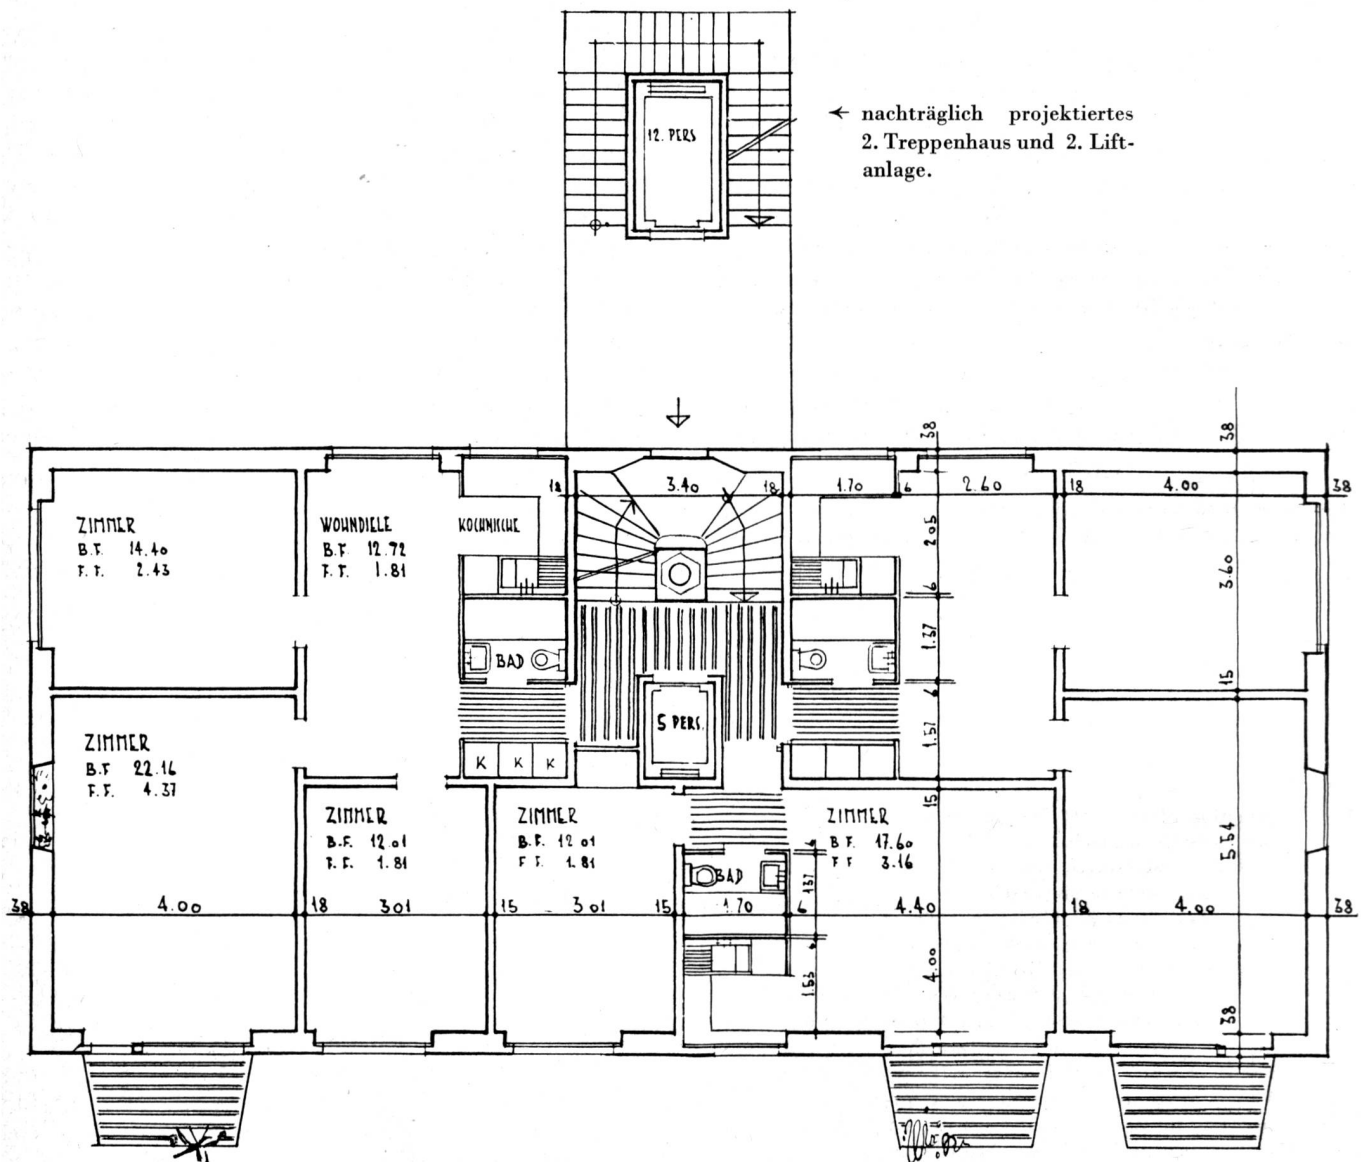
Grundriss eines Normalgeschosses. Nach dem ursprünglichen Projekt sind pro Stockwerk drei Wohnungen vorgesehen. Der Grundriss entspricht einem normalen Dreispännertyp, wie er für 4–6 Stockwerke üblich ist. Als vertikale Verkehrsanlage sind eine 1,25 m breite Treppe und ein Lift (Kabinengrösse 90 × 115 cm) vorgesehen, was völlig ungenügend ist. Auf die Beanstandung des Versicherungsamtes hin wurde eine zweite Liftanlage und eine zweite Treppe vorgesehen. Der Müllbeseitigung wurde keine Aufmerksamkeit geschenkt. Nach dem 1. Projekt standen im eigentlichen Hochhaus den Bewohnern keine Abstellräume und Estriche zur Verfügung. Nach der neuesten Eingabe sind in einem Attikageschoss Estrichräume vorgesehen. Für 54 Wohnungen und das Café-Restaurant im Dachstock sind Kellerräume mit total 80 m² Grundfläche, Kellerzugänge eingeschlossen, projektiert.
